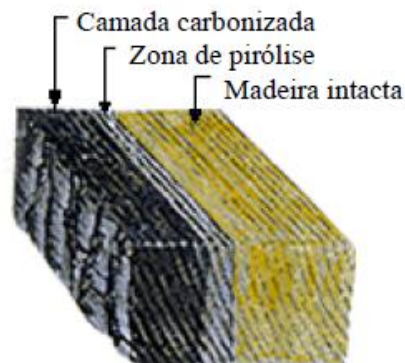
Zonas de degradação numa secção de madeira, (Barreira, 2008)
